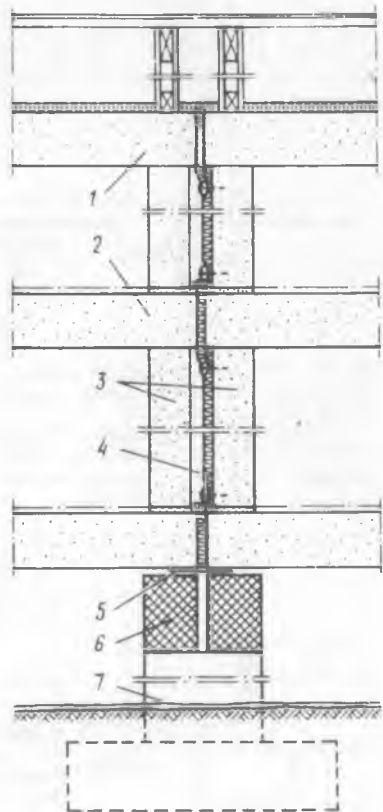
Пример выполнения общей стены в жилых домах типа "террас-хаус" (примыкающий один к другому) с полным разделением для достижения хорошей звукоизоляции
